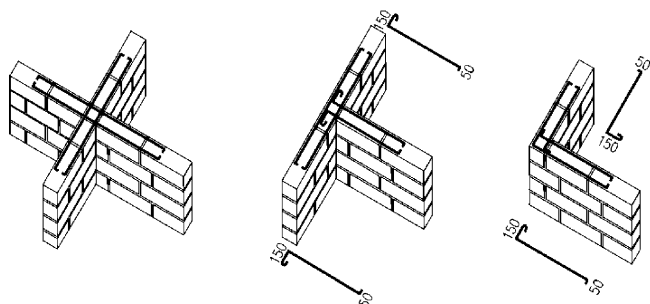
纵横墙连接处拉结钢筋做法(单位:mm)
